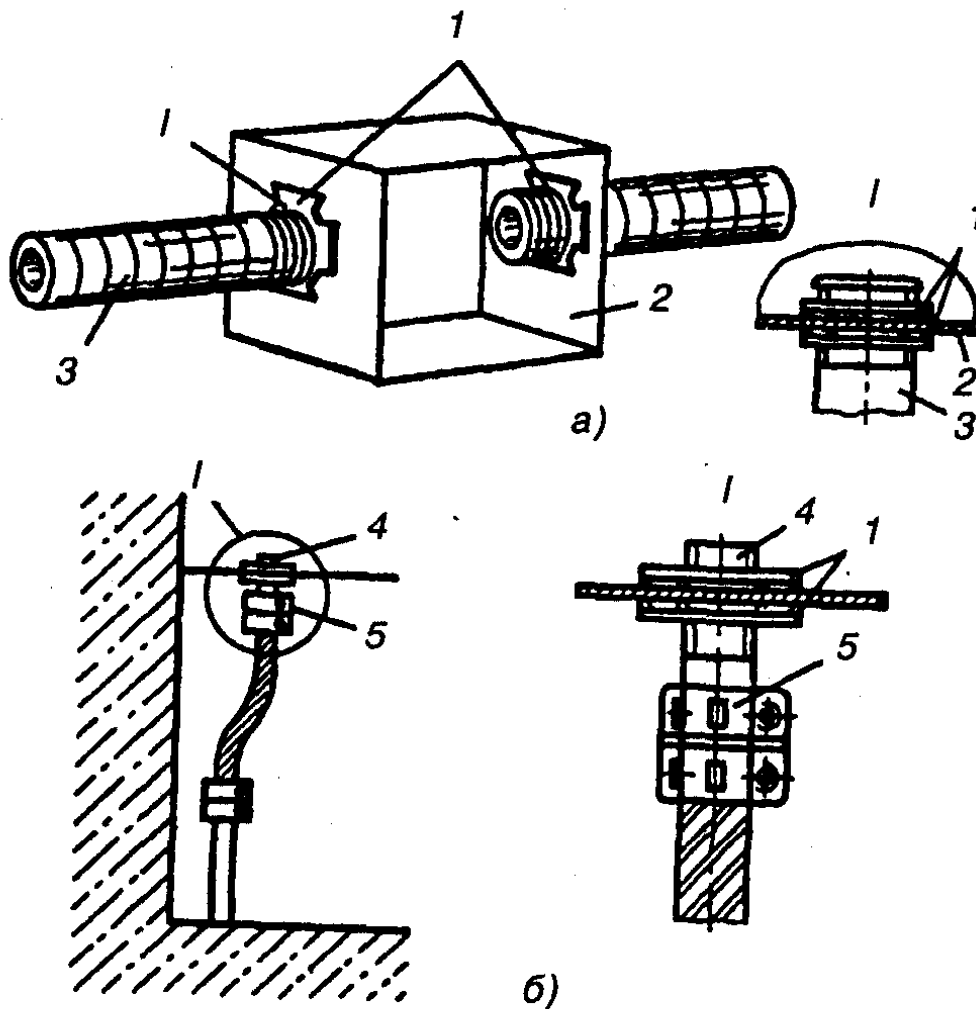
Примеры монтажа электропроводок в трубах:
